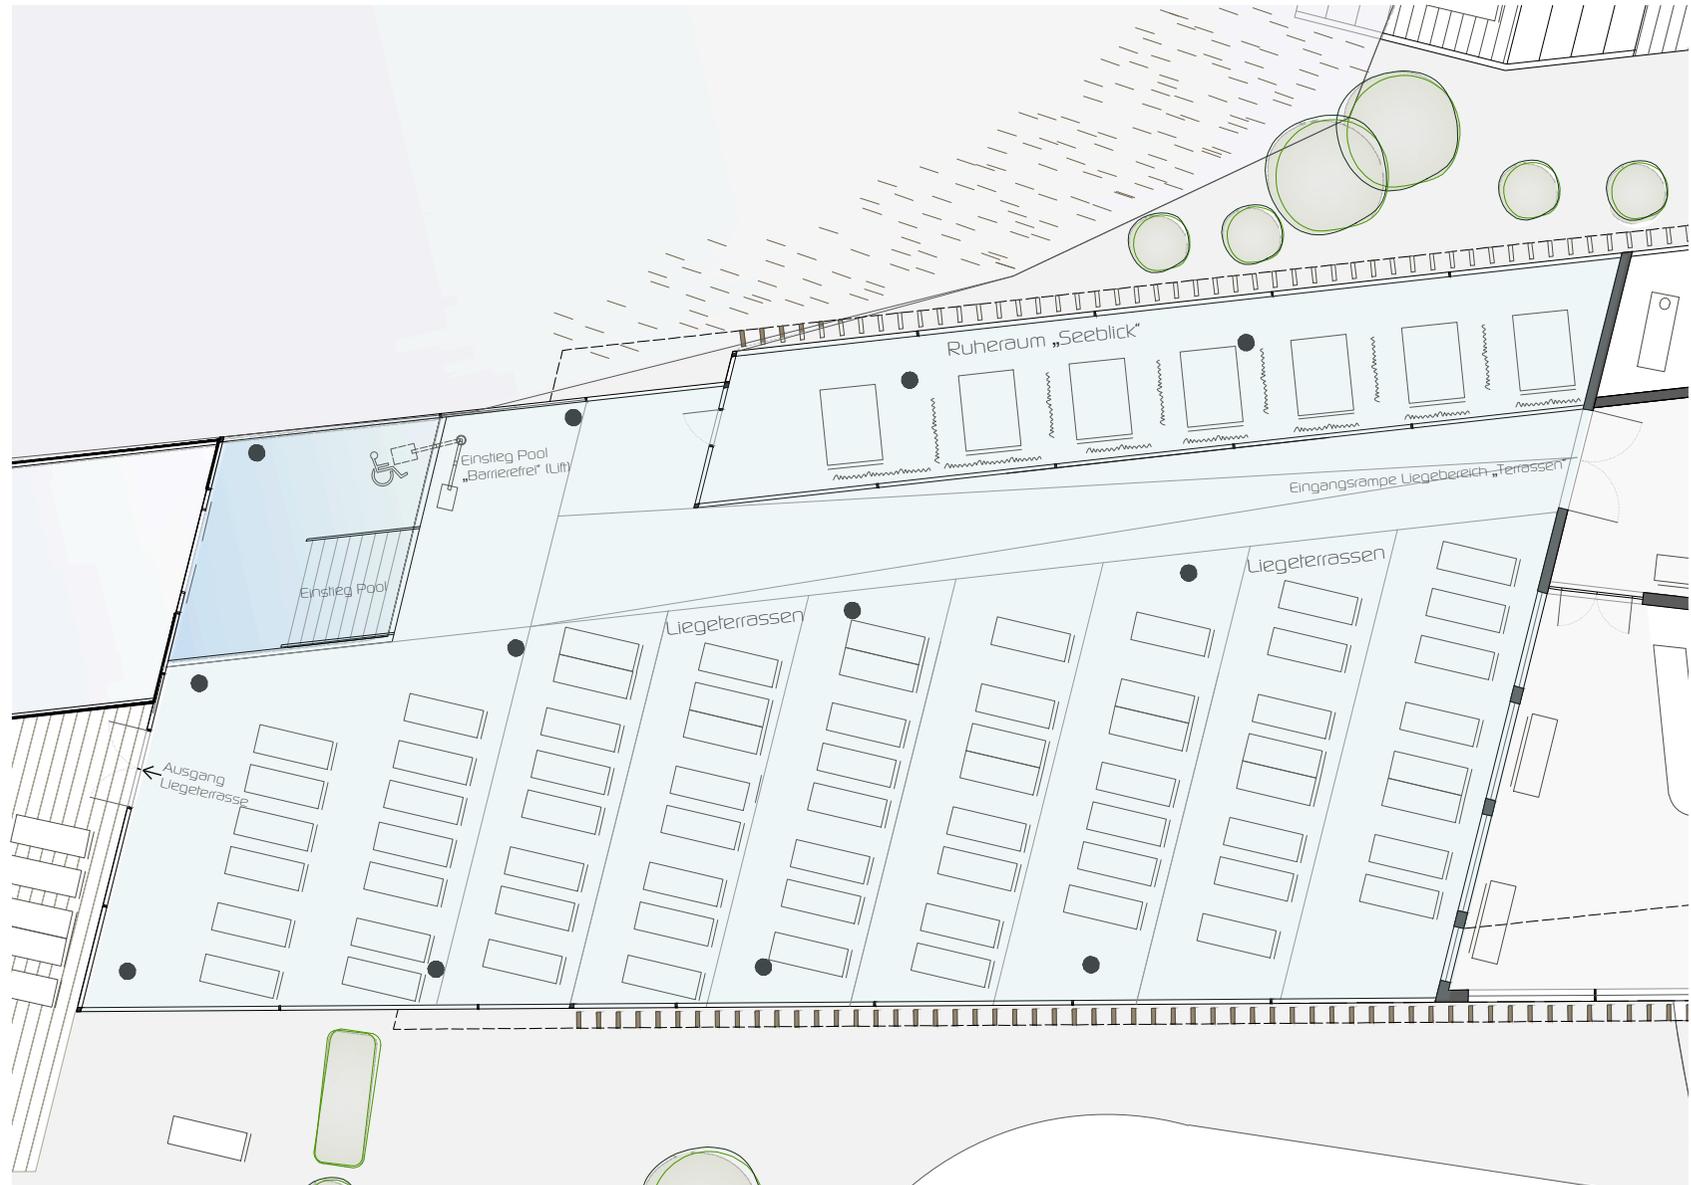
Grundriss EG Wellnessbereich Liegen ‚Terrassen‘
